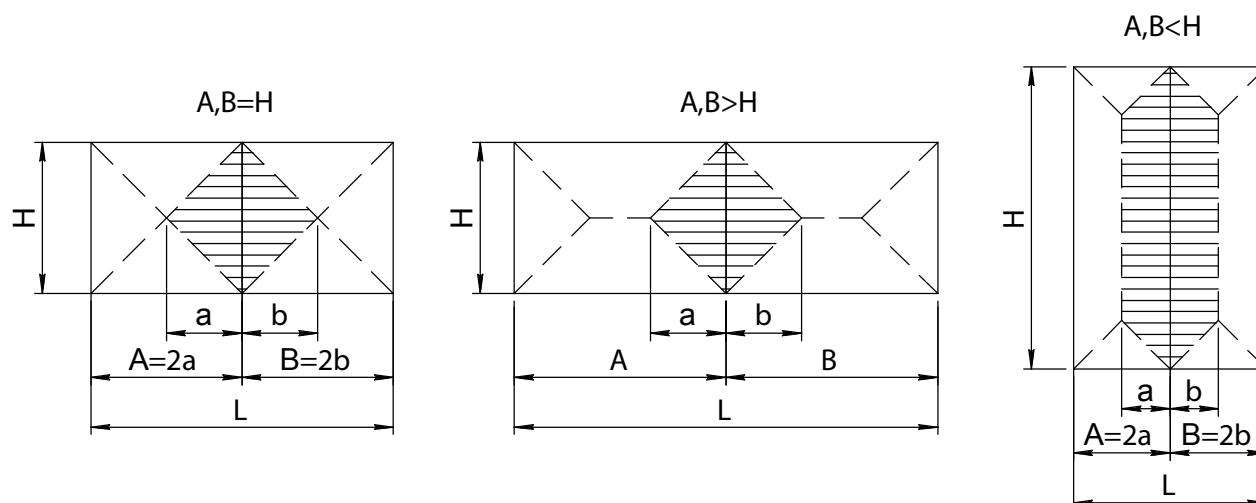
Расчетная схема ветровой нагрузки W_m
